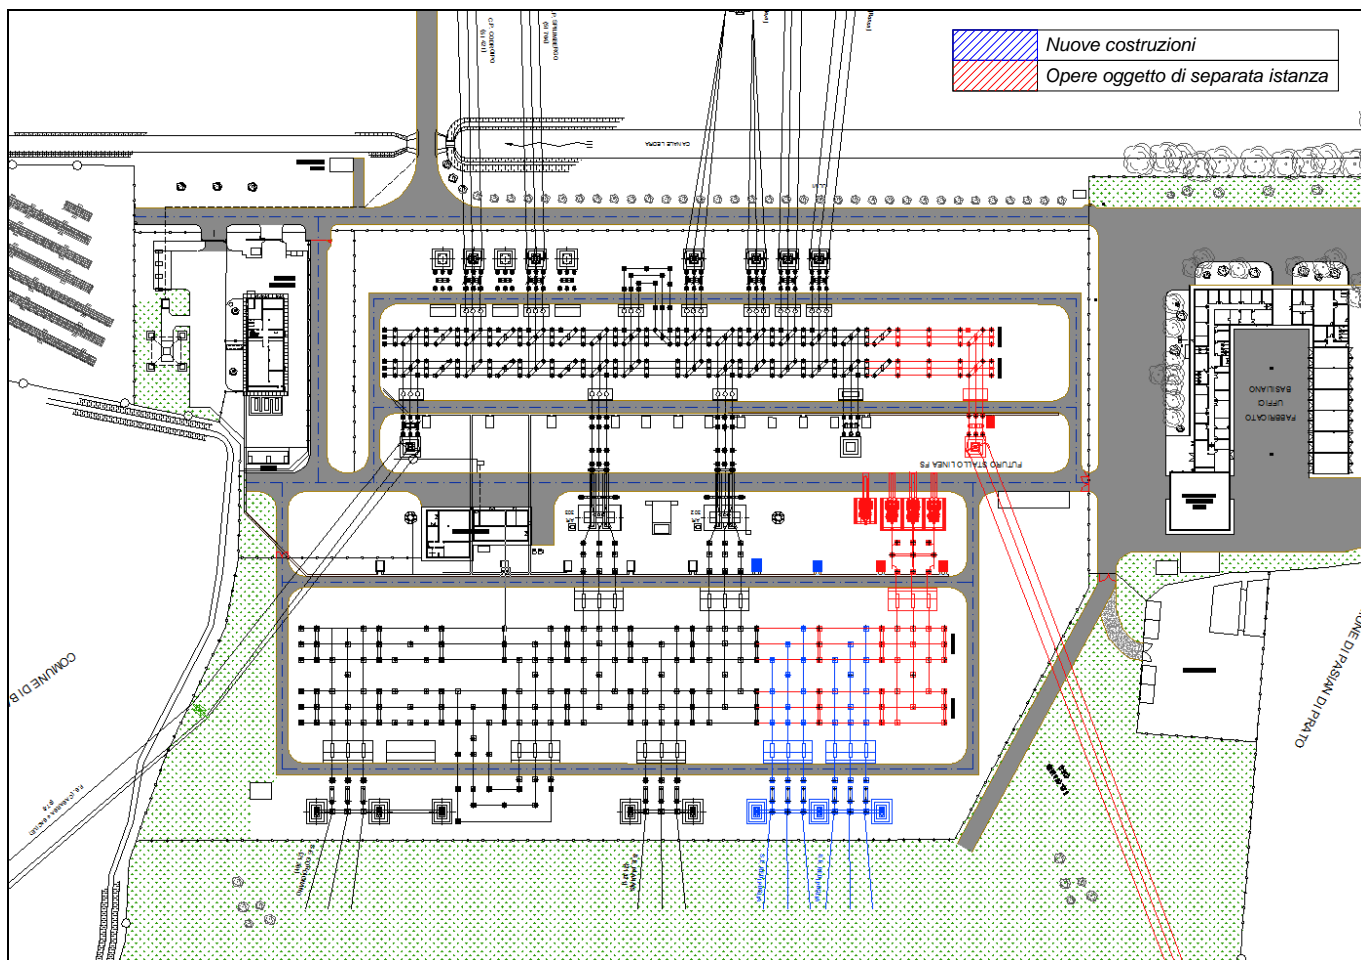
Planimetria elettromeccanica della S.E. 380/132 kV di Udine Ovest
